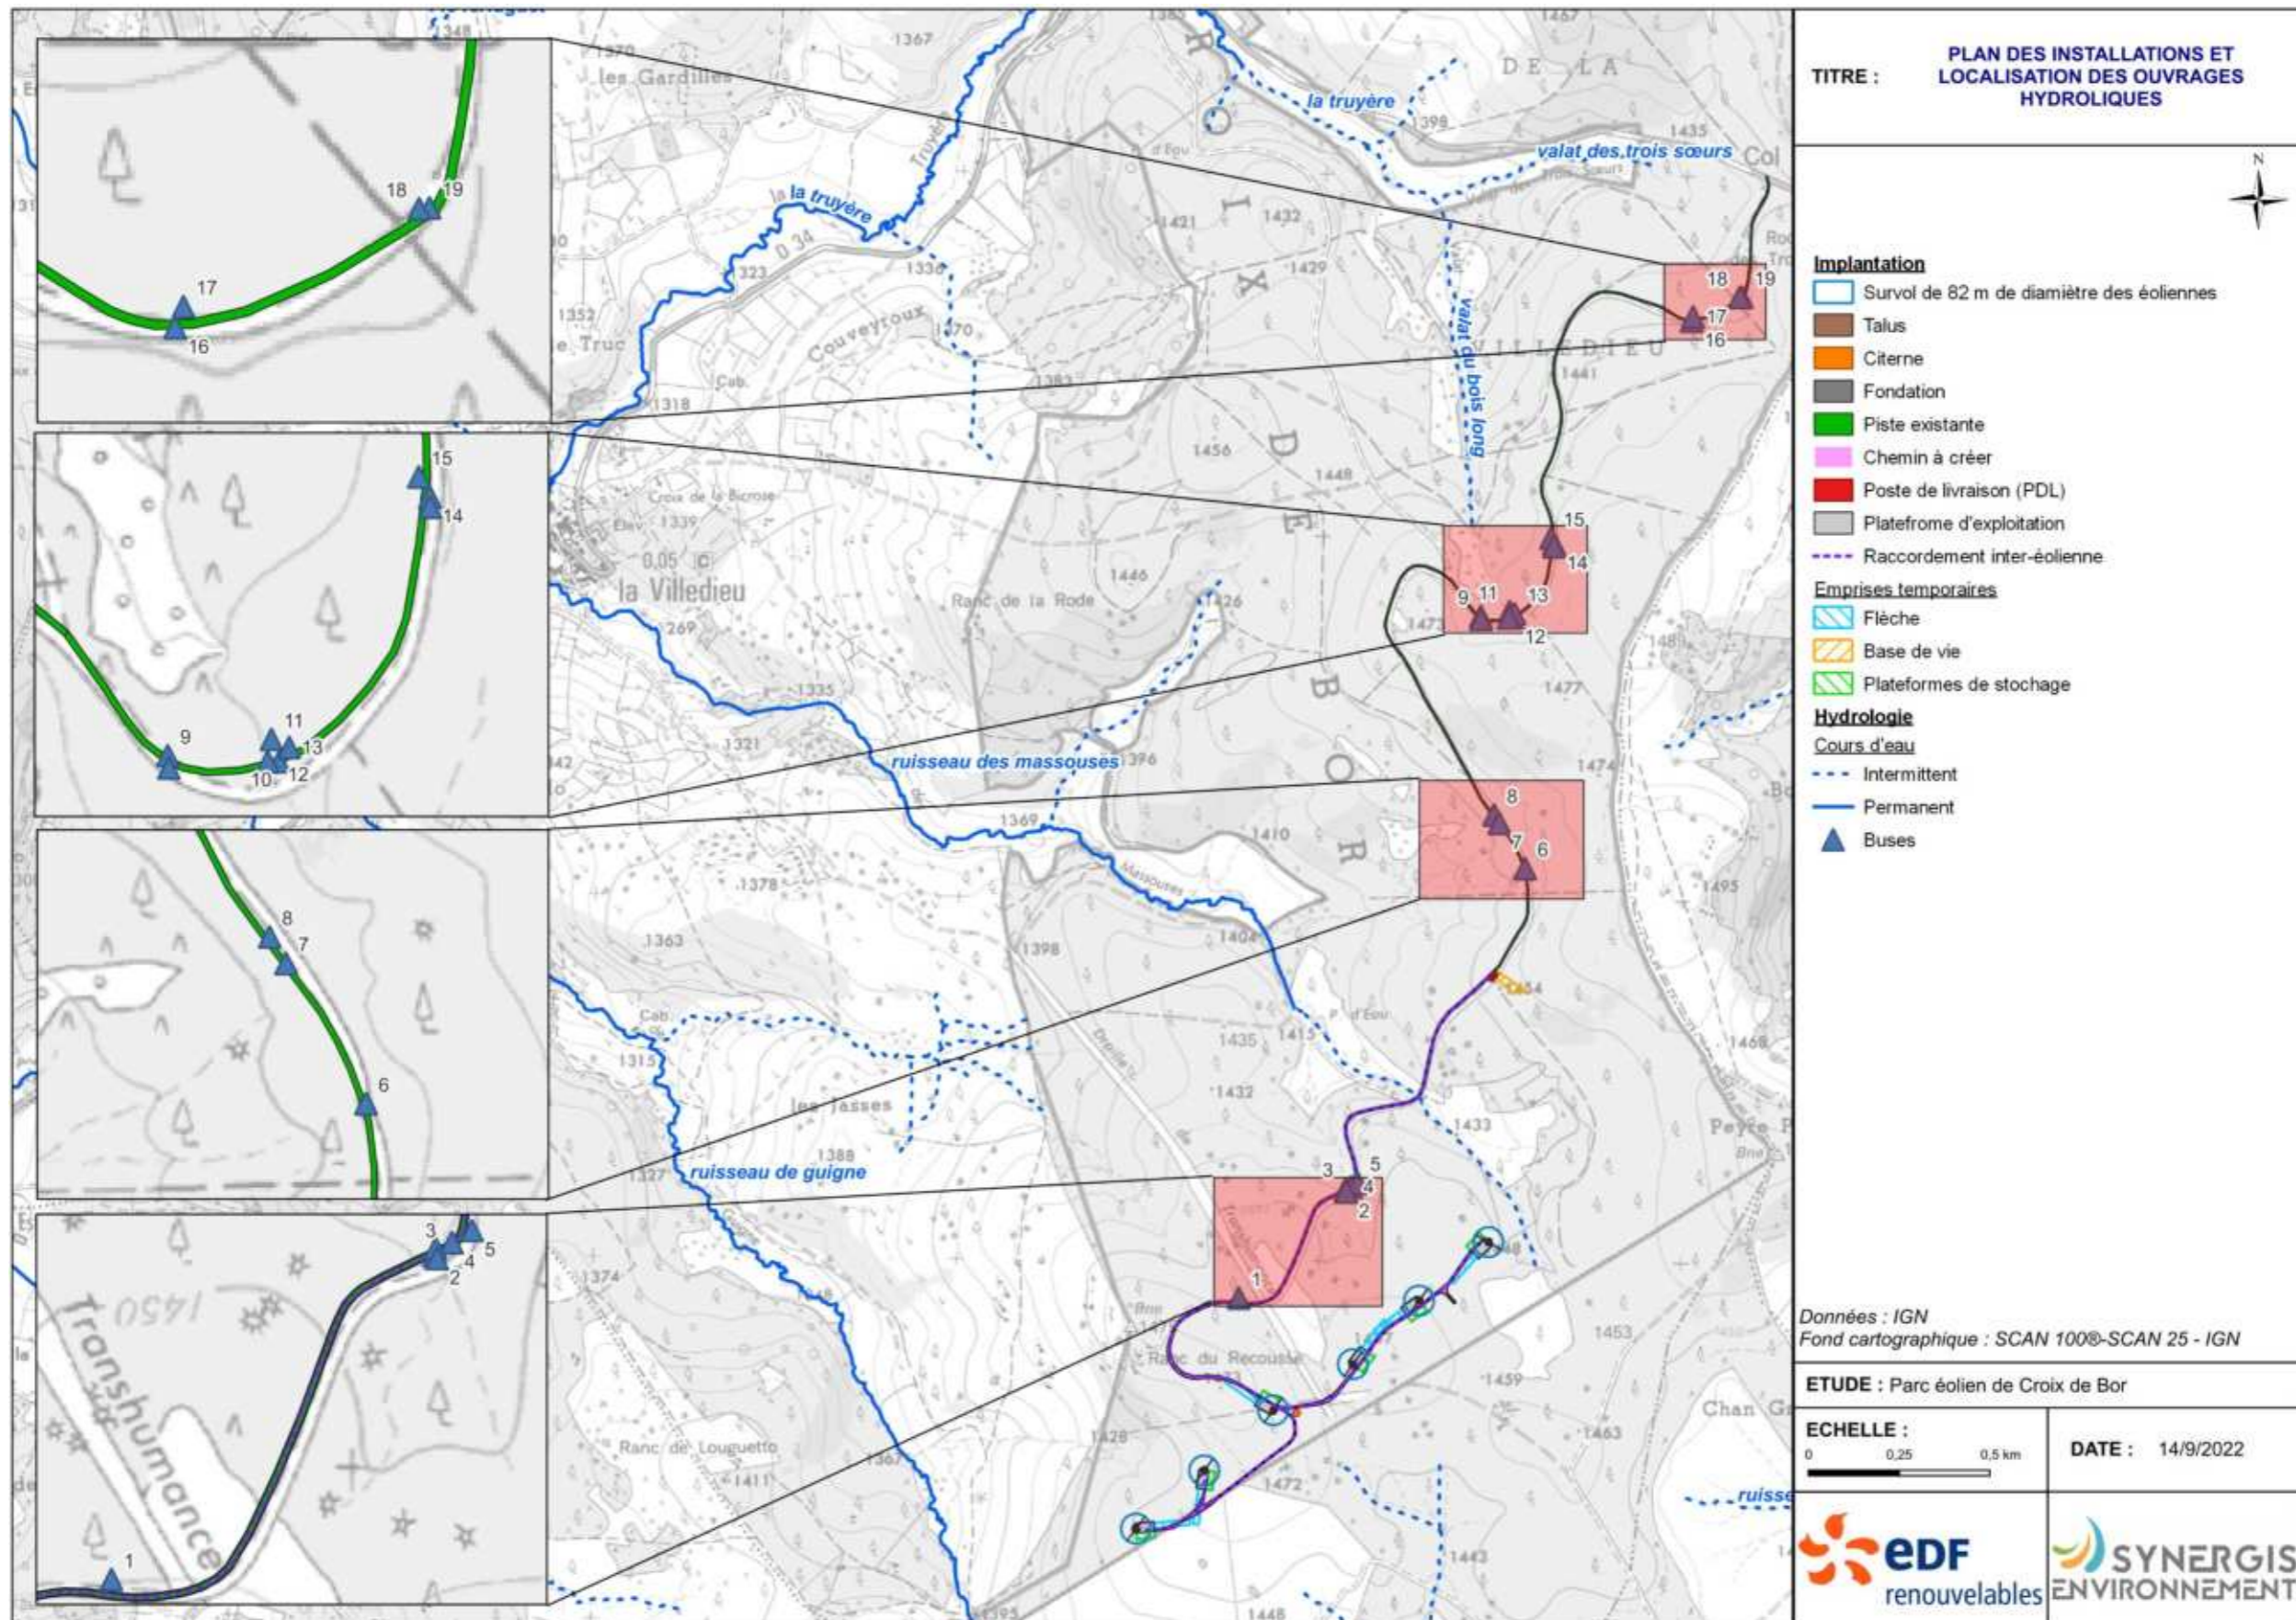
Plan des installations et localisation des ouvrages hydrauliques
